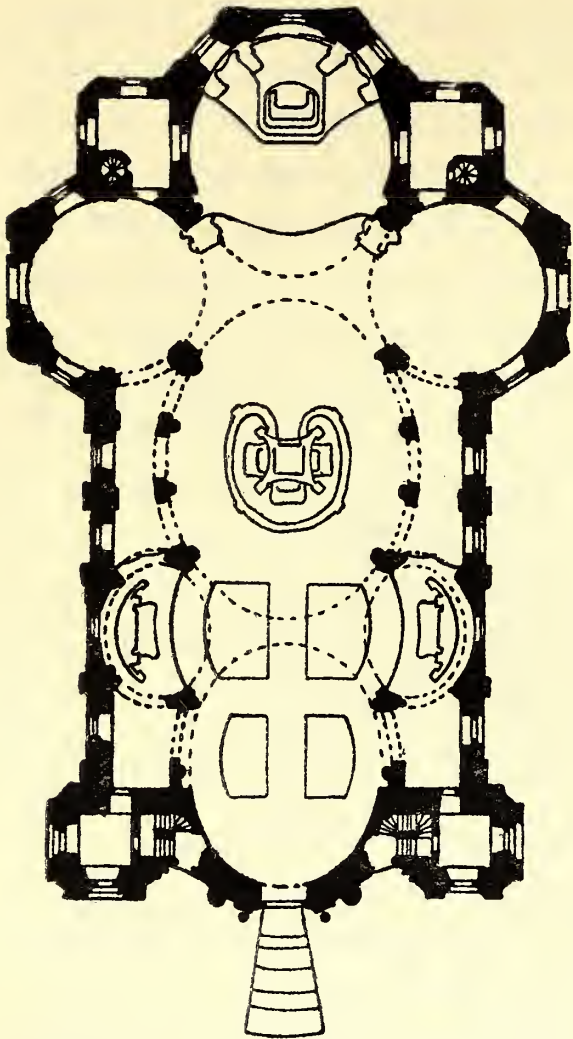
Wallfahrtskirche, Vierzehnheiligen.
